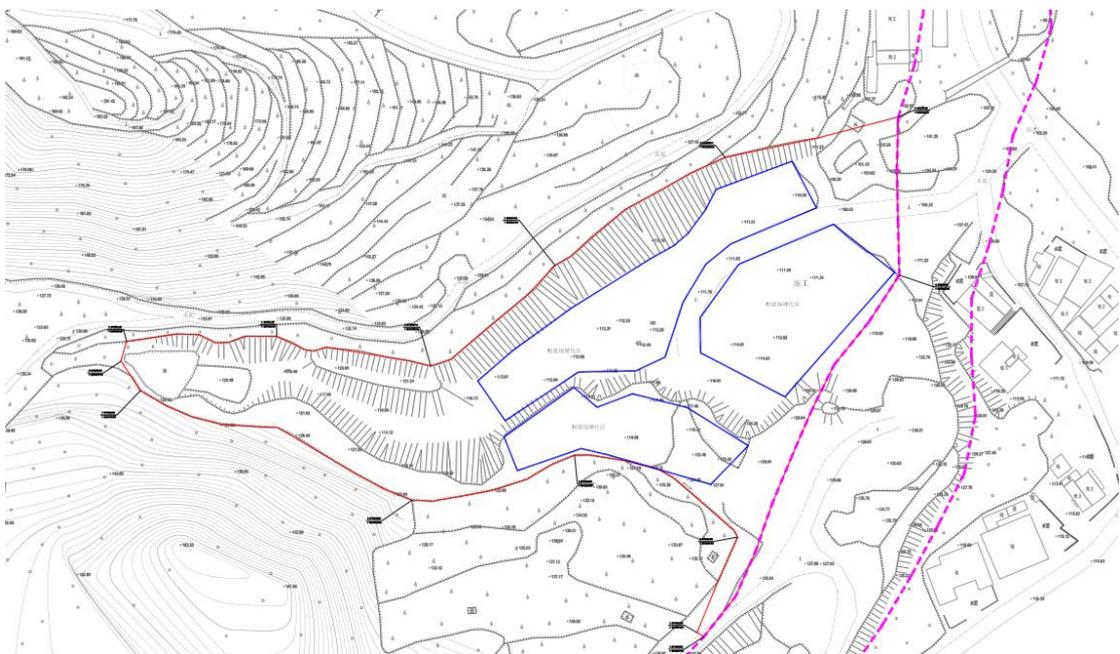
制梁场规划平面布置图（蓝色为制梁硬化区域）
